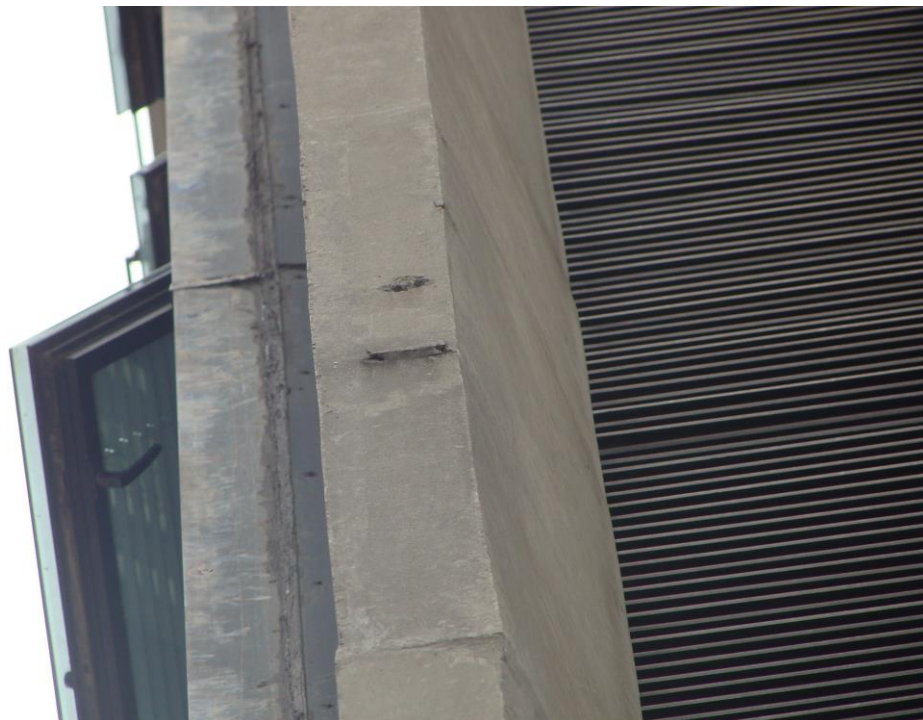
Armadura exposta pilar P11 (3º pavimento) (19/11/2013)
